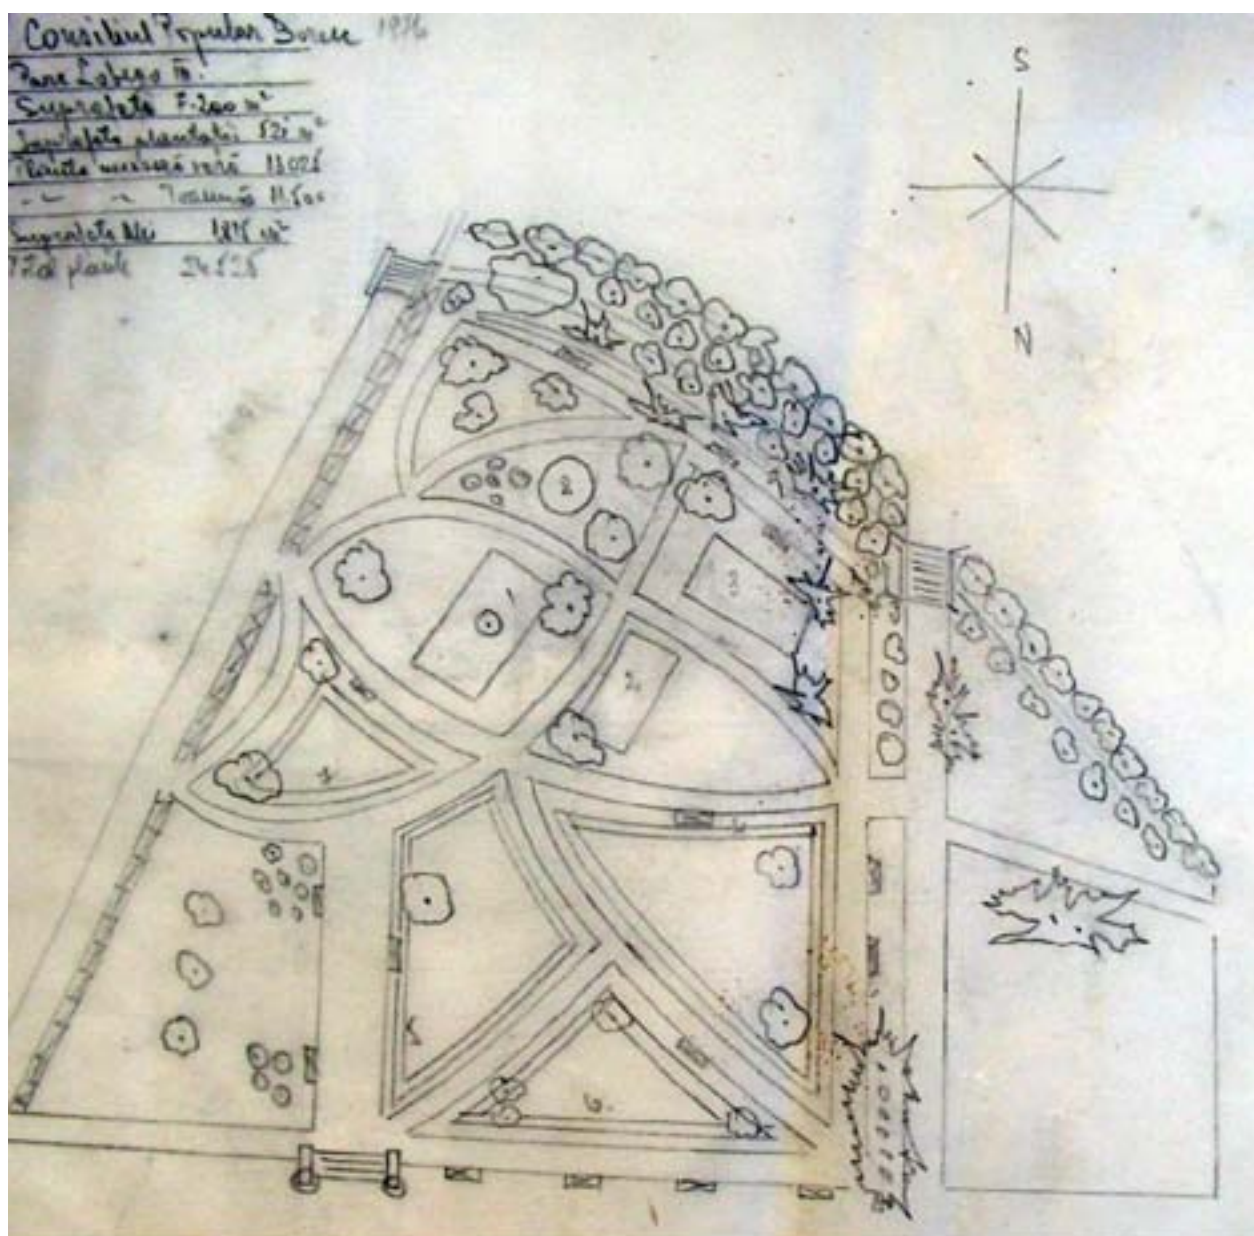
Plan de plantare vegetație a parcului Lobogó din 1976
